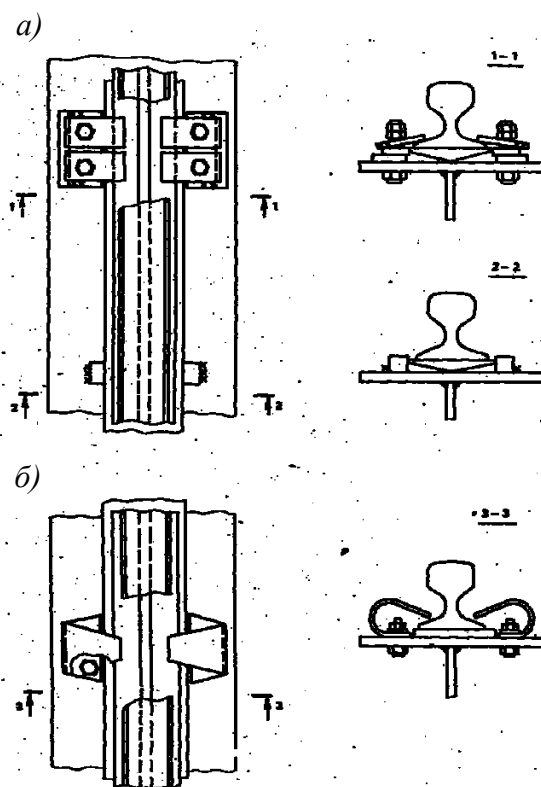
Крепление подкранового рельса: а – с использованием тангенциальной прокладки; б – на низко модульной упругой прокладке
